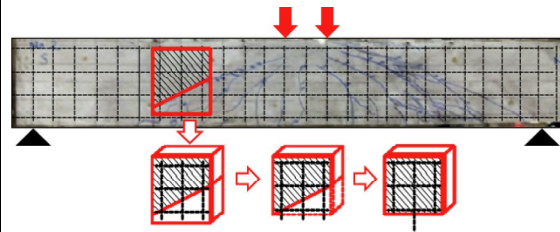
コンクリート梁側面の CFRP 補強と要素試験体
